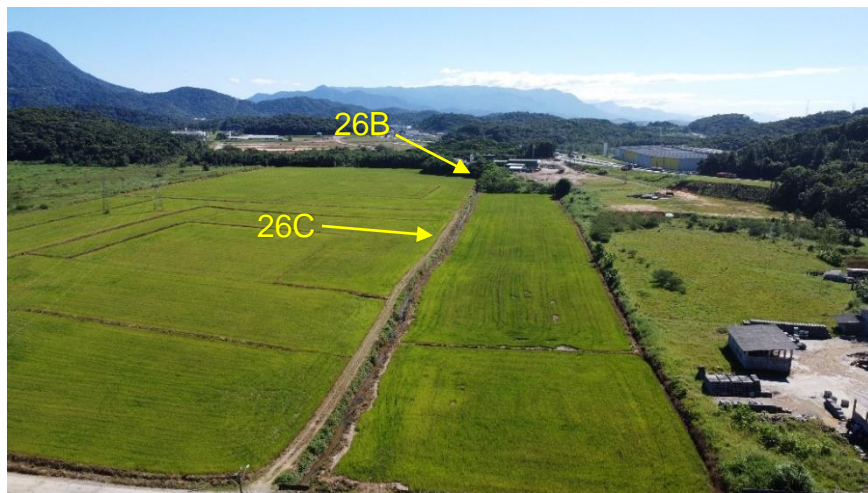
Vista para trechos 26B e 26C. Fonte: Autores.
